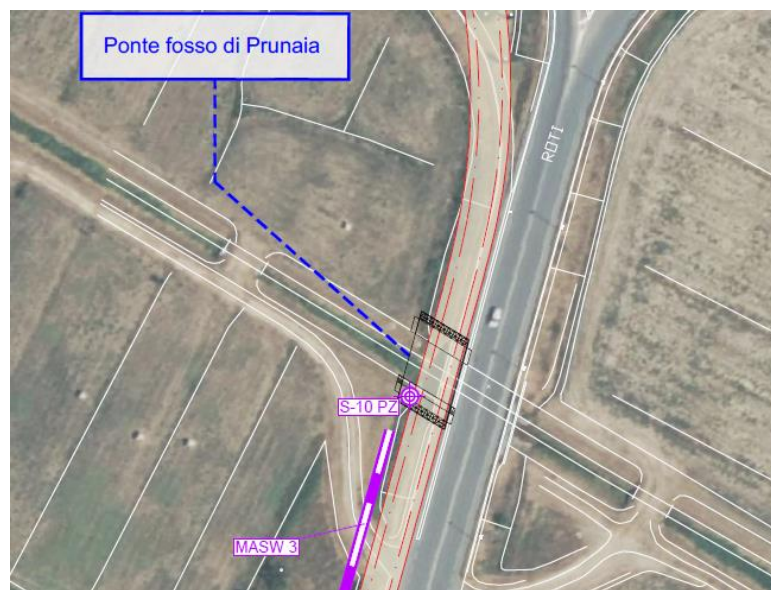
INDIVIDUAZIONE PLANIMETRICA DEL NUOVO PONTE FOSSO DEL PRUNAIA
